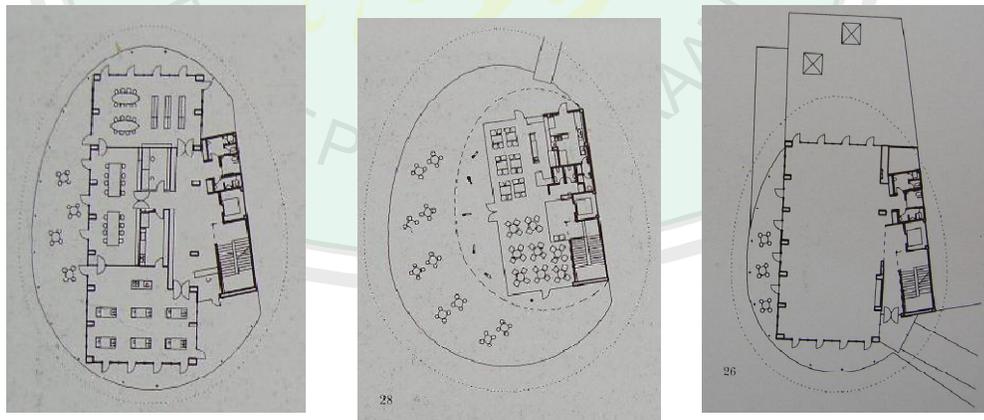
Denah lantai satu green house, denah plaza, denah lantai tropikal *Yamamashi fruit museum
